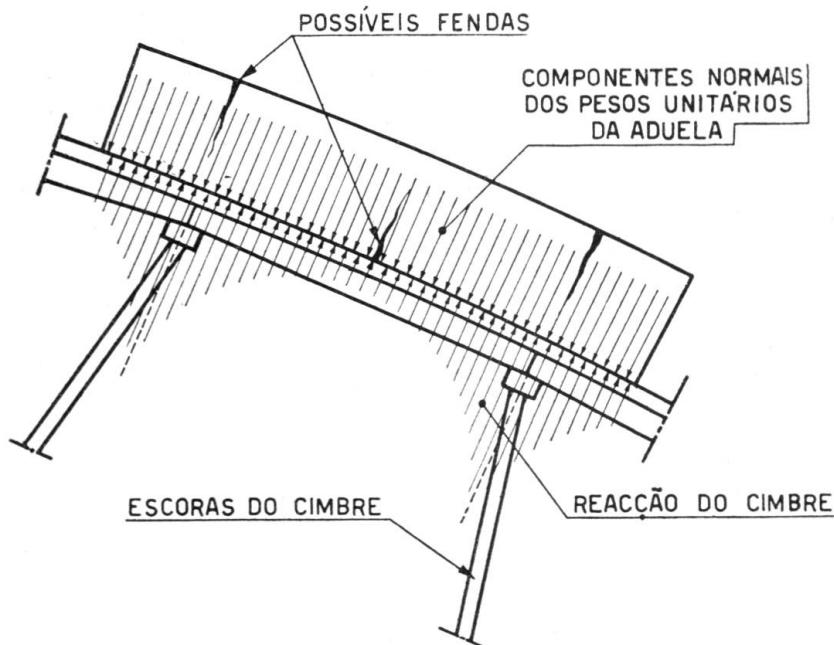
Esquema duma aduela dum arco betonado a toda a altura das secções
